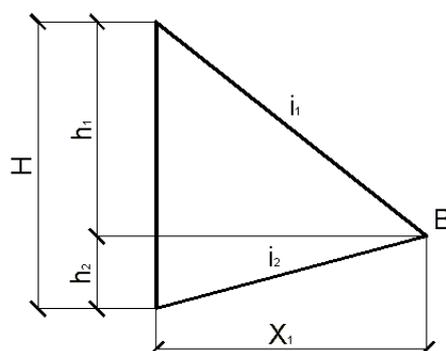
Расчетная схема нахождения отметки подошвы насыпи
